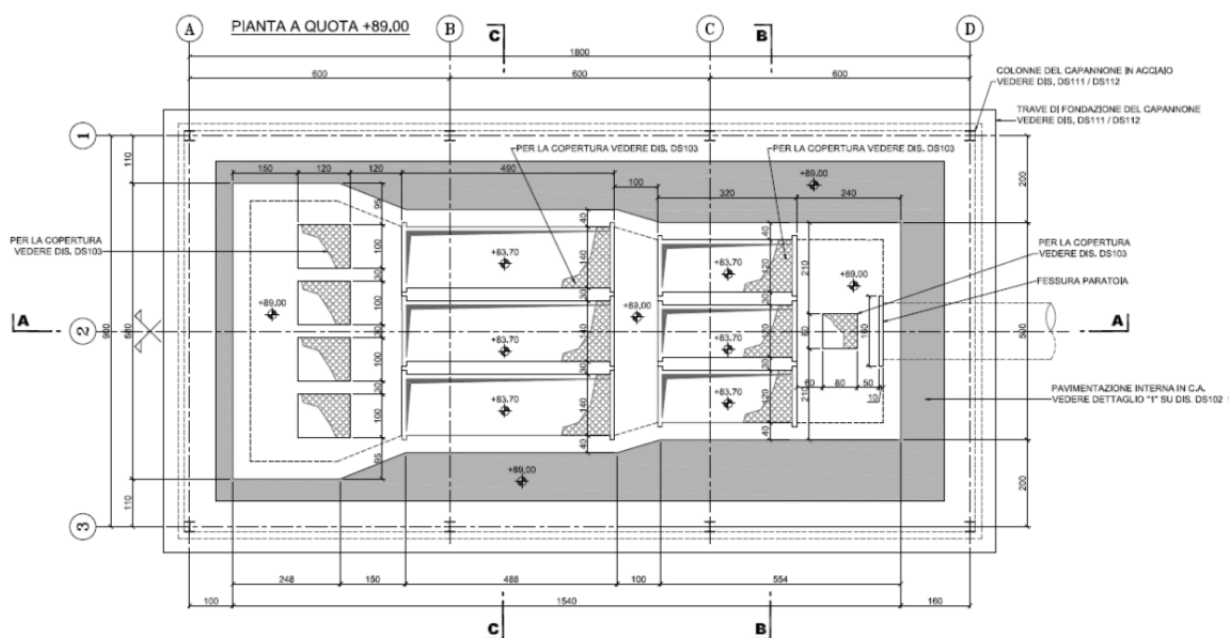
STAZIONE DI GRIGLIATURA E SOLLEVAMENTO INIZIALE – PIANTA
